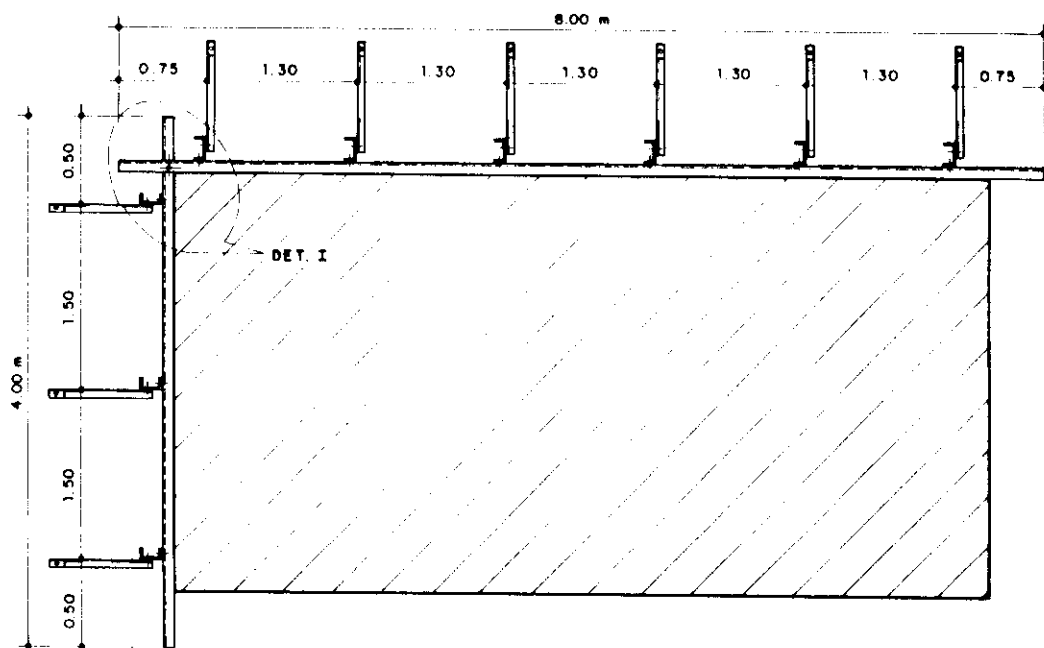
PLANTA DO ESCORAMENTO METÁLICO PARA MONTAGEM DOS PAINÉIS
